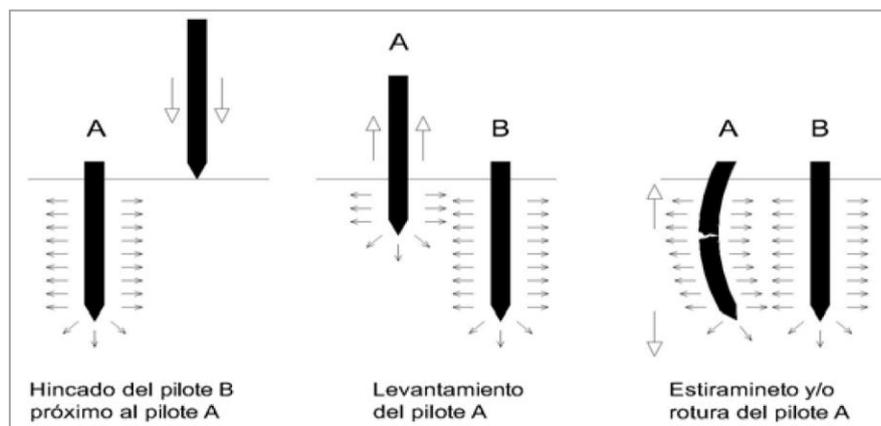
Lesiones o daños en pilote por hincado próximo de otro pilote
